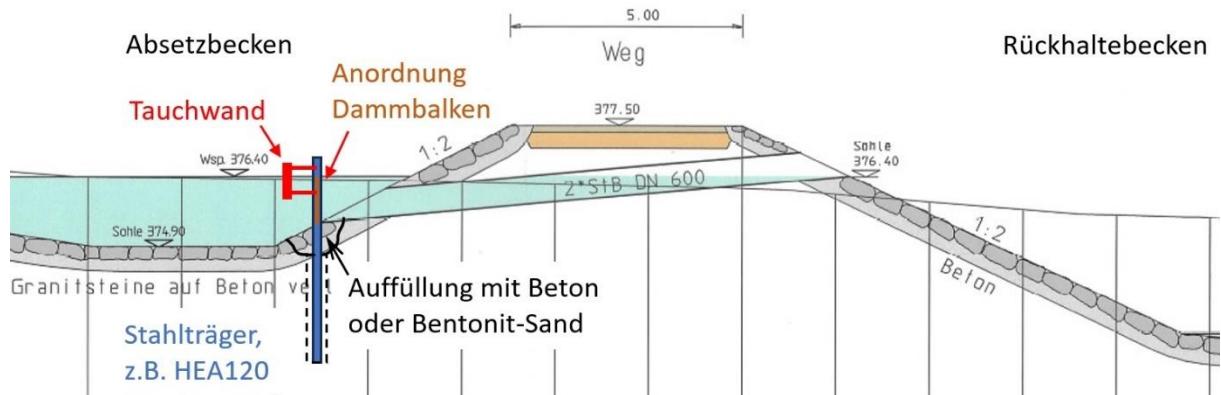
Skizze Überlauf und Tauchwand an Absetzbecken, Befestigungsvariante mit Einbindung in den Untergrund
